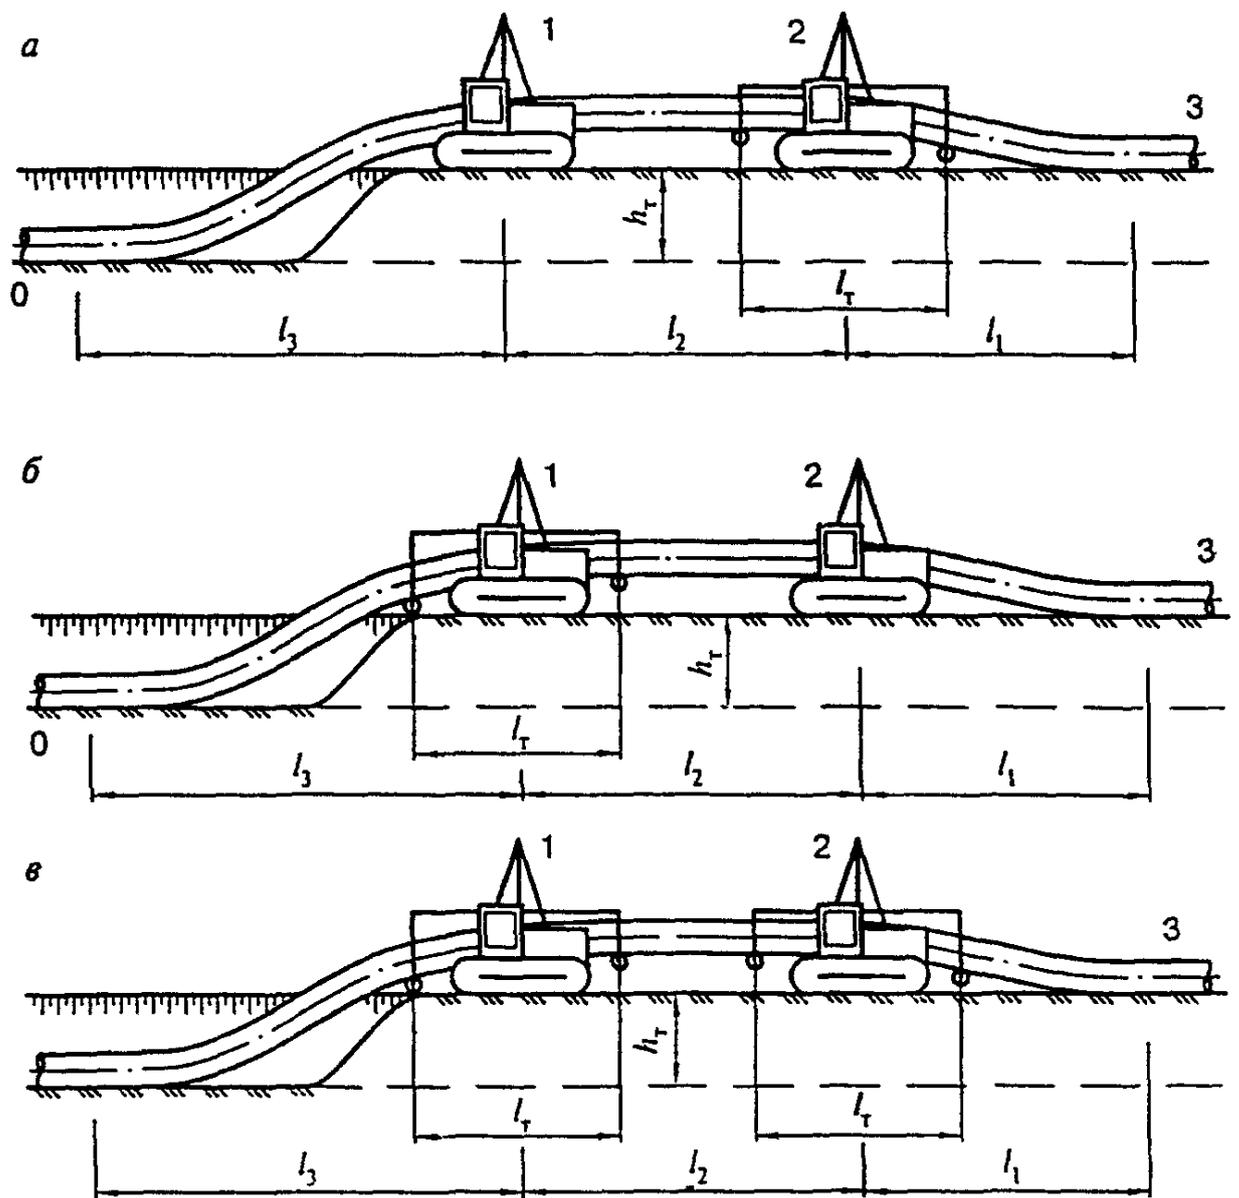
Схемы укладки газопроводов с бермы траншеи с применением траверс [12]
